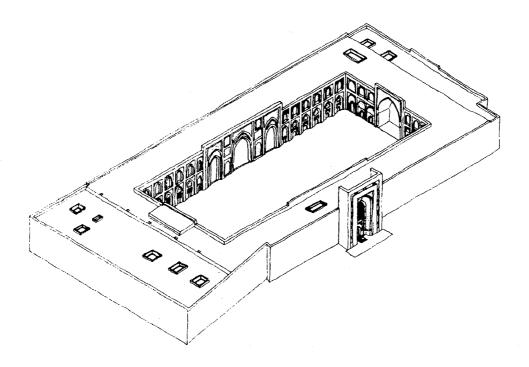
مسقط أفقي لجامع قمرية ببغداد . (عن: Ulucam) .
